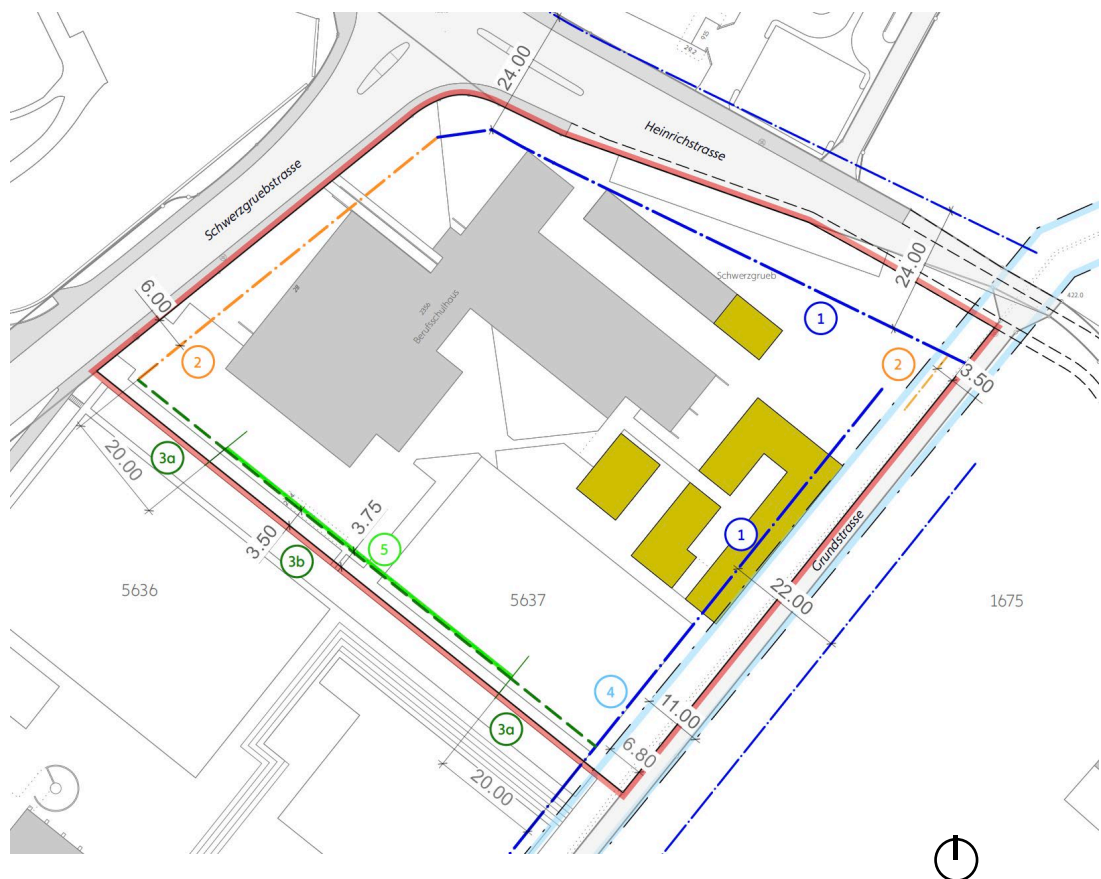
Baurechtsplan mit Verkehrsbaulinien (1), Strassen- und Wegabständen (2), kantonalem Grenzabstand (3) Die Unterteilung in 3a und 3b ist im Baurechtsplan (Unterlage C4) ersichtlich.; Gewässerraum (4) und der Grunddienstbarkeit Näherbaurecht (5)
